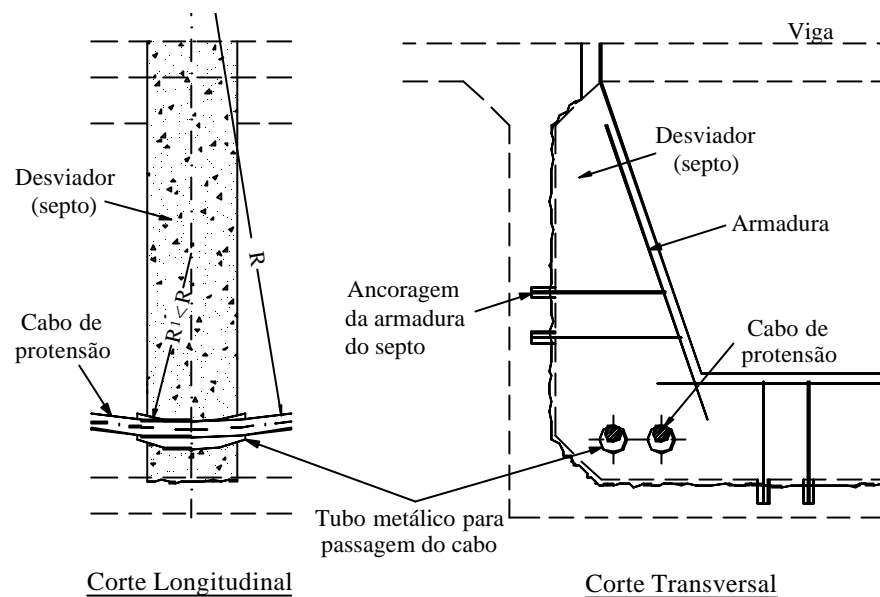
Desviador de concreto em viga de seção caixão (MALLET, 1996)
